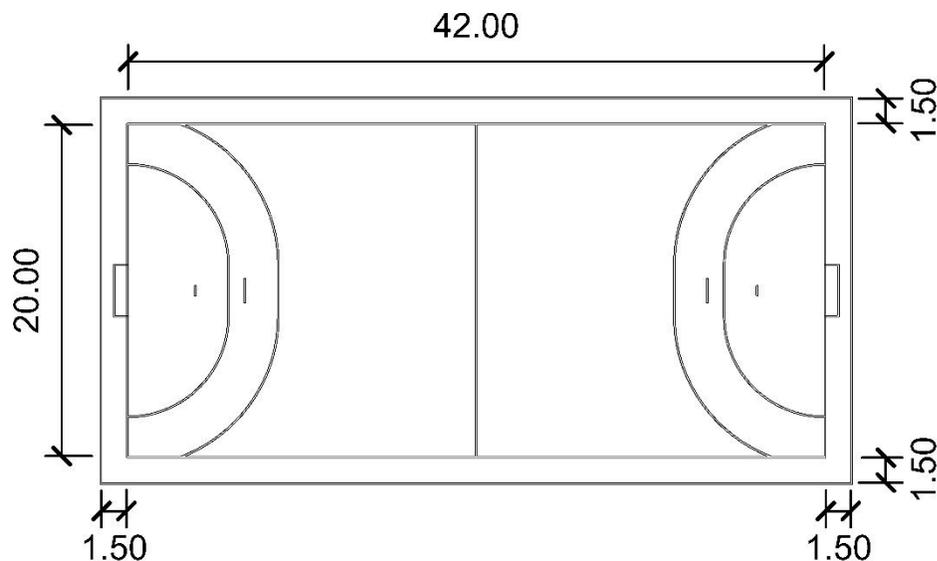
Dimensiones utilizadas para la Cancha de Balón mano. Elaboración propia, (noviembre 2018).
